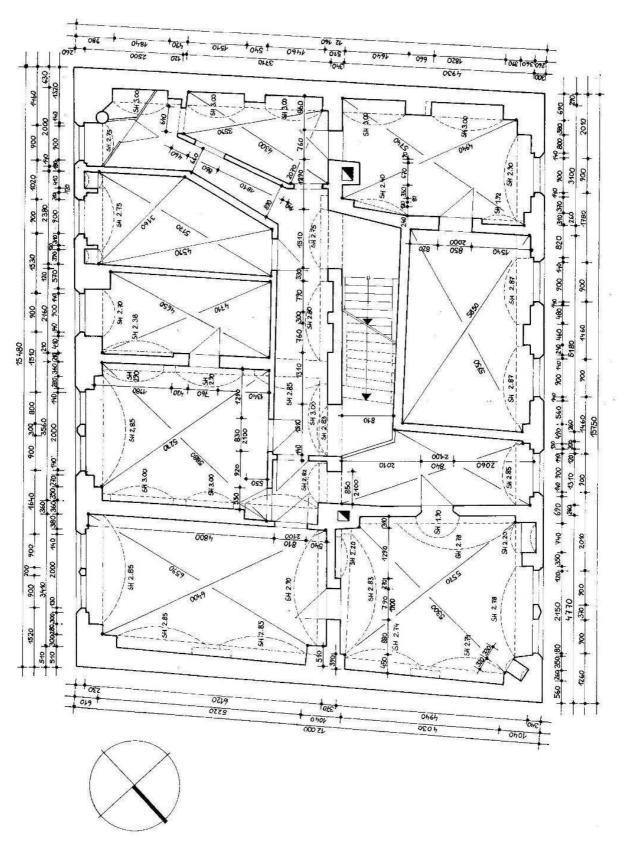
Webergasse 1, Grundriss des 1. Obergeschosses vor der Sanierung
